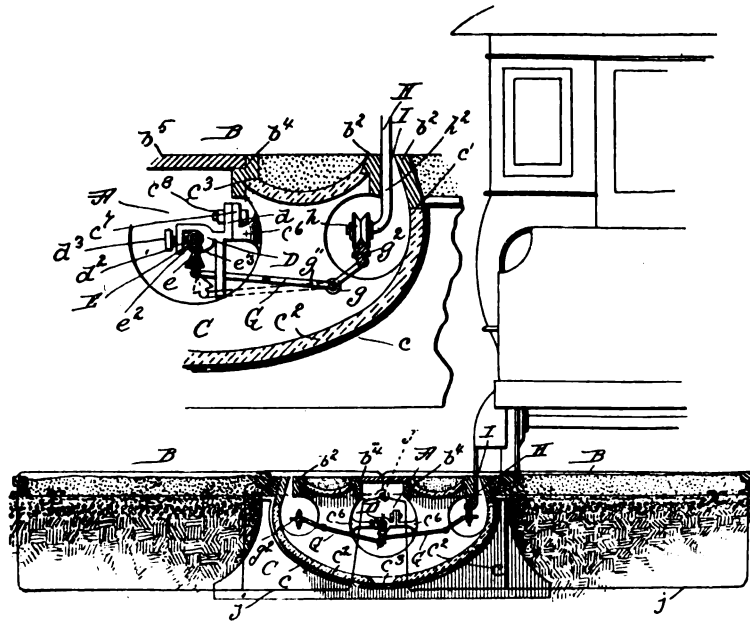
et 32. — Conduite souterraine T. Armat à sections et à contact instantané. Coupe transversale et détail.
